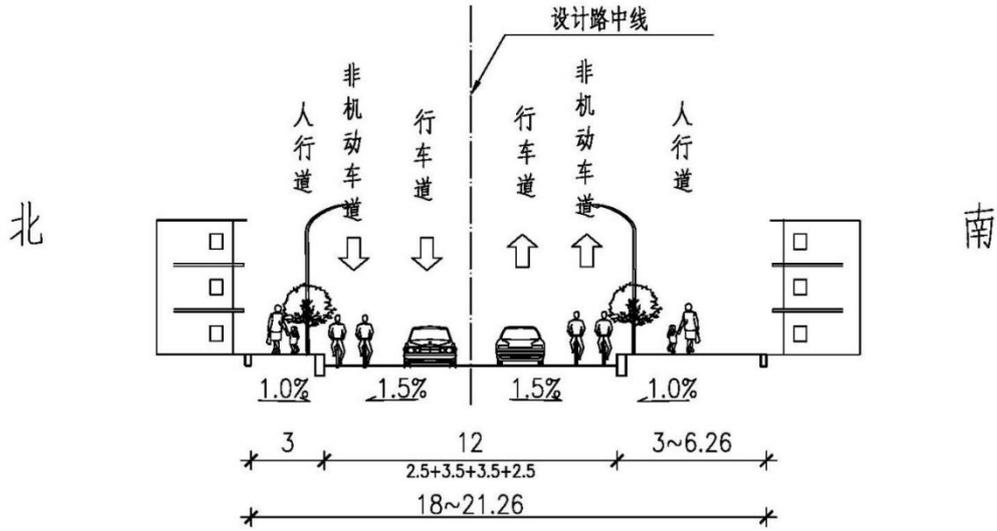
丁字沽零号路（向东道~四新道）设计横断面图
